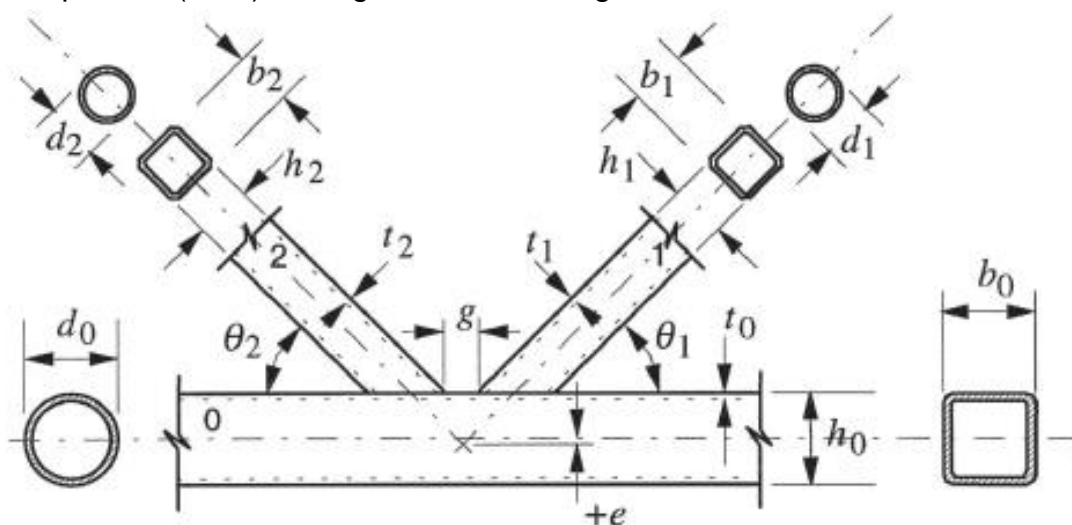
Hohlprofil K-Knoten mit Spalt [39]
